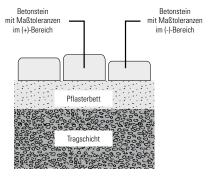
Verlegte Betonsteine auf abgezogenem Pflasterbett
